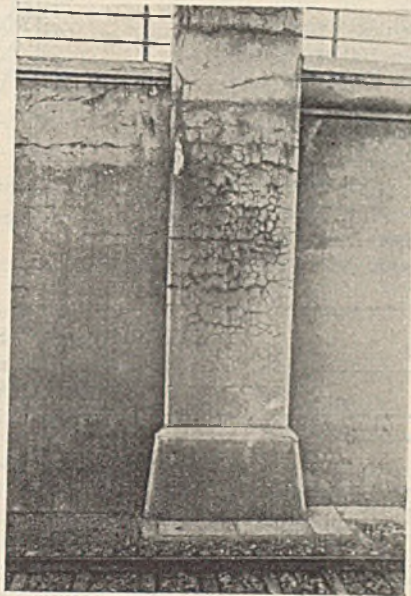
Stützmauer in Stampfbeton mit Verputz.
